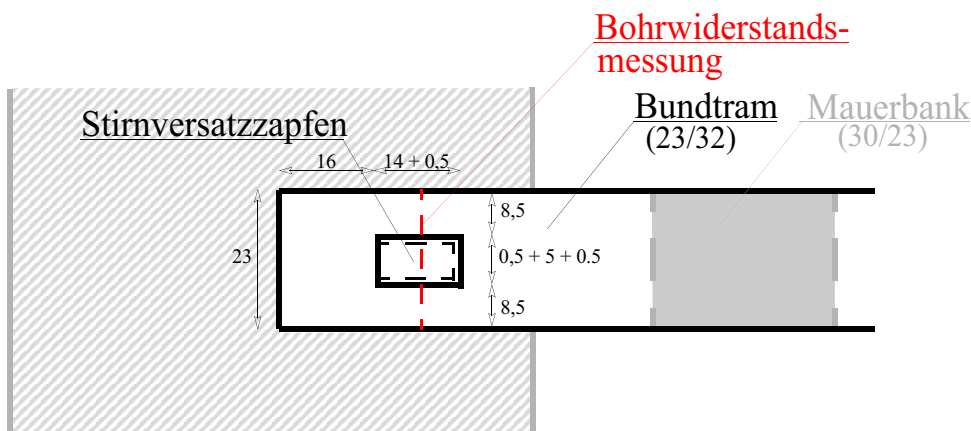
Anschluss: Sparren-Bundtram (Grundriss)
